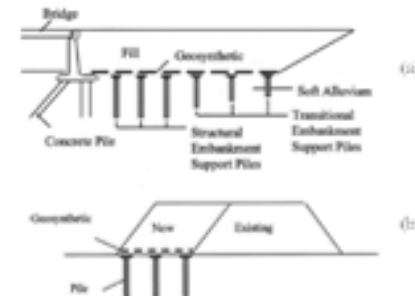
Tipici interventi di consolidamento delle fondazioni di rilevati stradali (a, rilevato adiacente alla spalla di un viadotto; b, ampliamento di un rilevato esistente) (da Han e Gabr, 2002).
